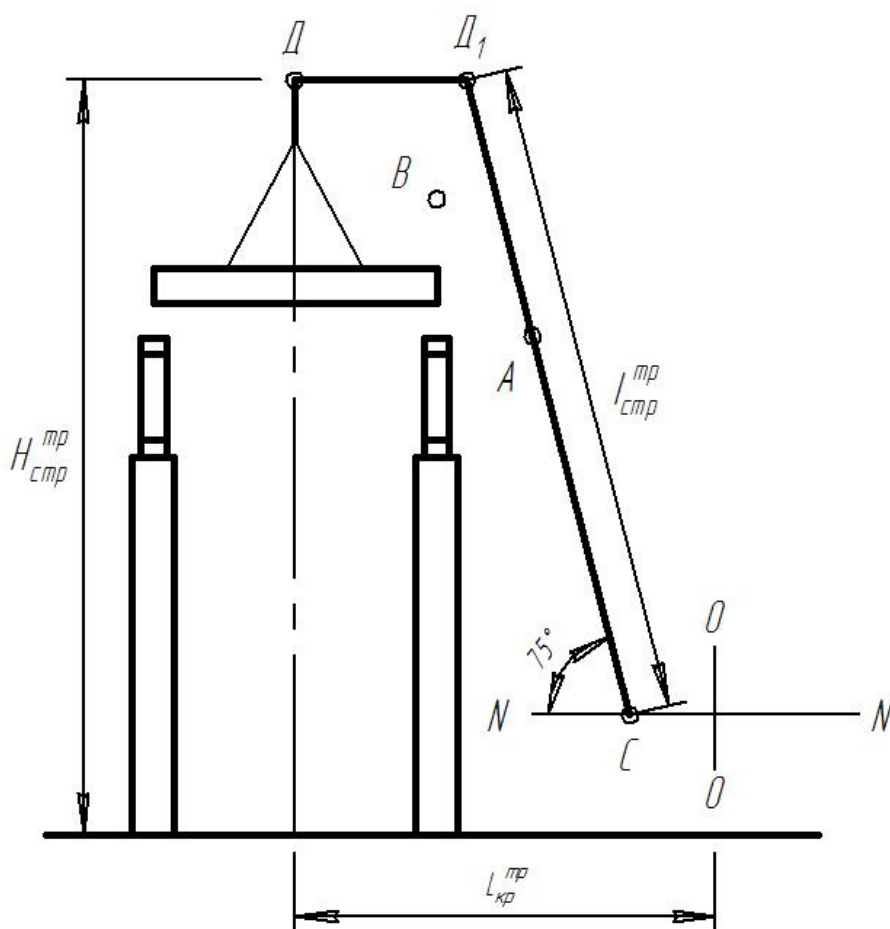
Схема определения параметров крана при монтаже плит покрытия
